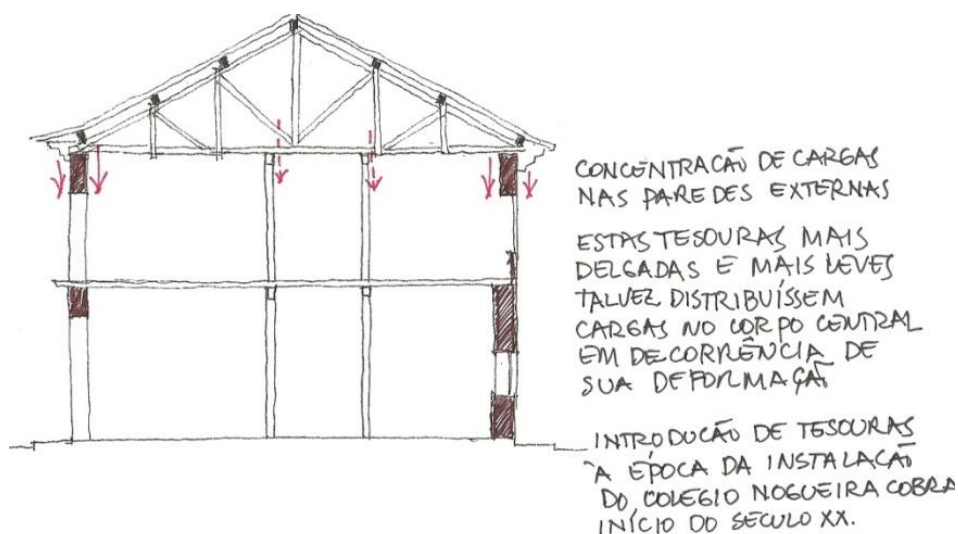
Possível Configuração da Estrutura de cobertura primitiva.
